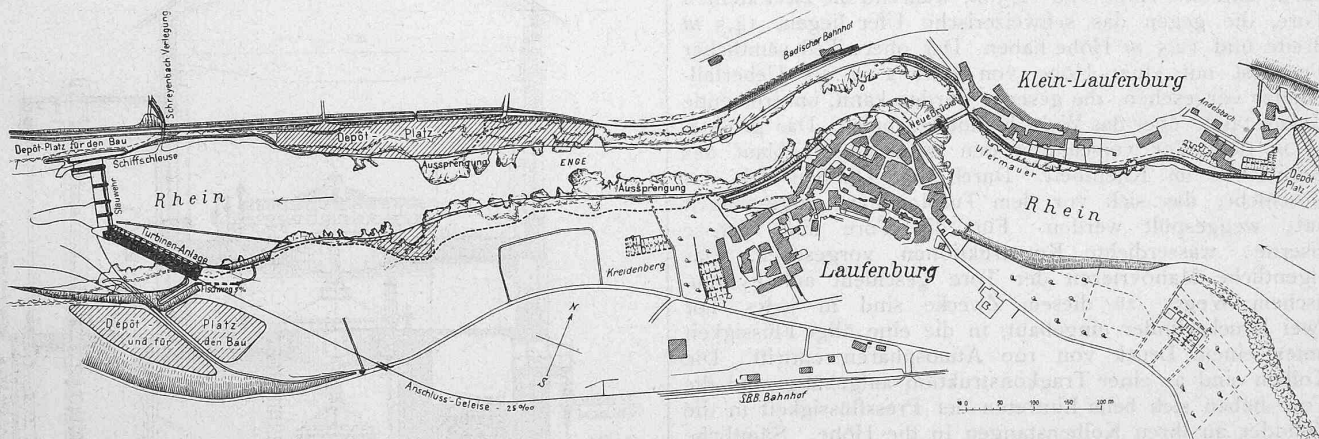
Lageplan der projektierten Wasserkraftanlage Laufenburg. — Masstab 1 : 8000.
